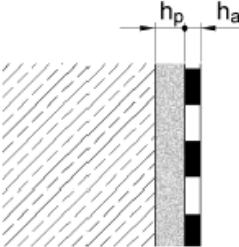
Pripevňovací prvok zabudovaný v betóne s povrchovou úpravou
